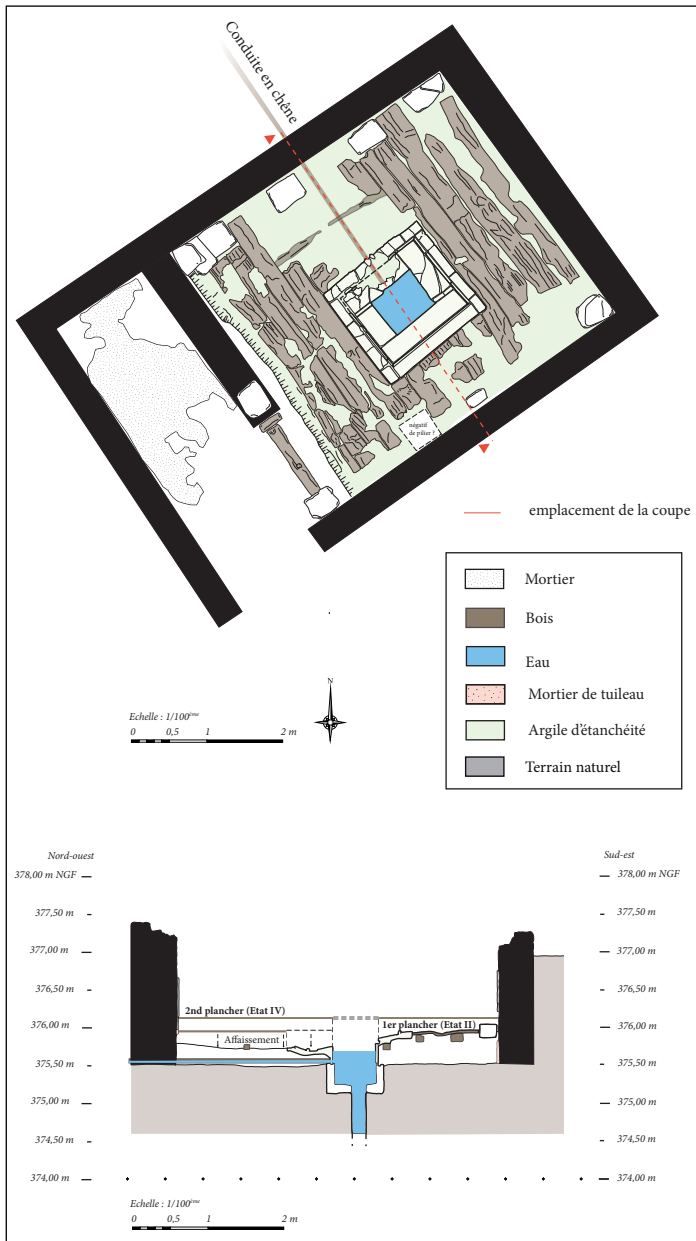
Plan et coupe nord-sud du bâtiment B (DAO : D. Martinez, Hades).
